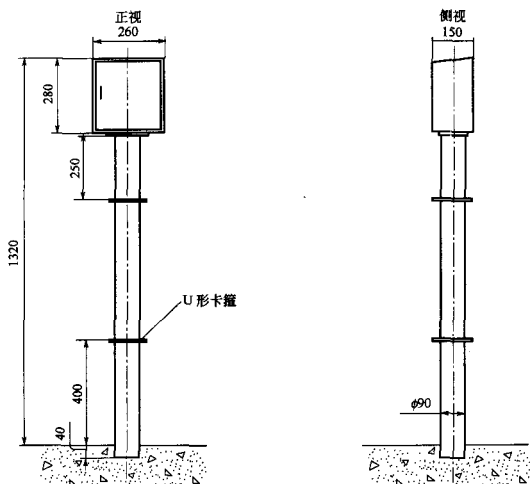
通话箱(方形)外形结构型式、基本尺寸及安装尺寸示意图
